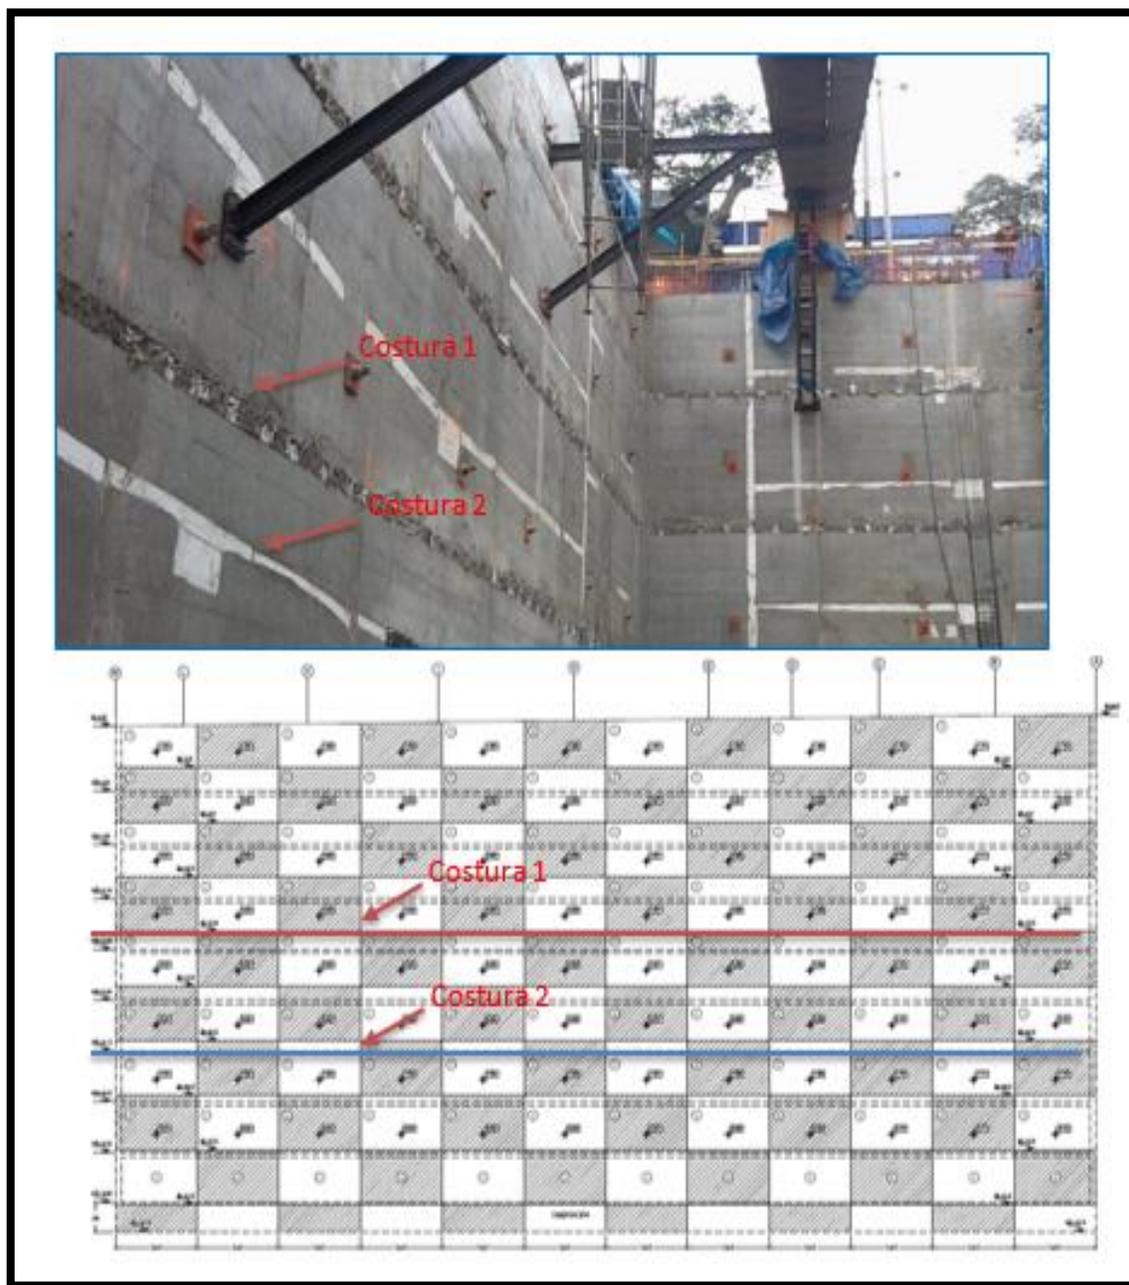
Imágenes de muros anclados en los que se aprecia las dos costuras. Costura 1: zona de encuentro de paños construidos y picado de cachimba. Costura 2: Intersección entre losa y muro.
